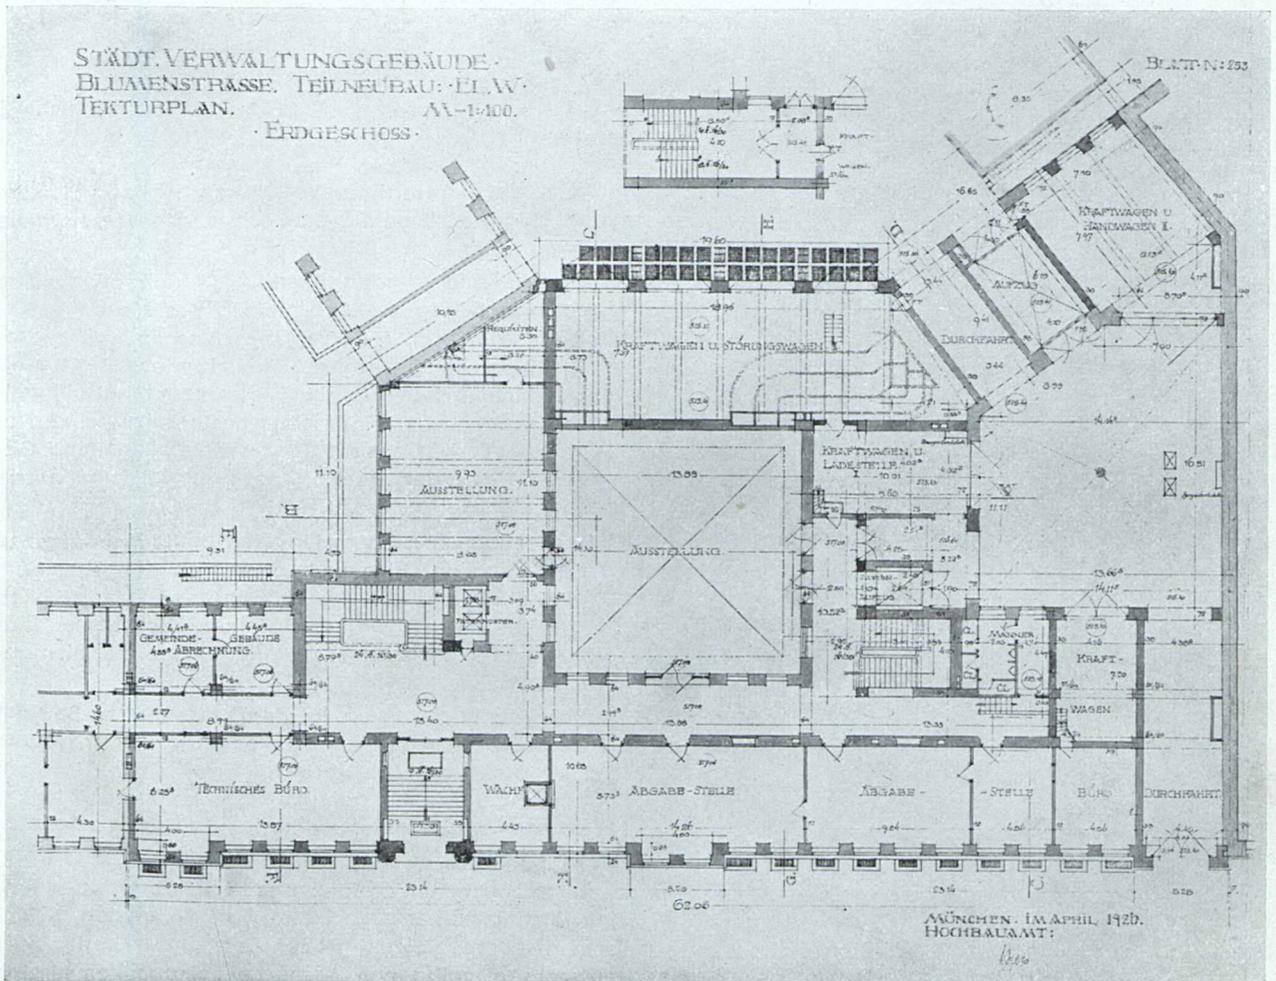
Bauteil Elektrizitätswerke, Erdgeschoß
